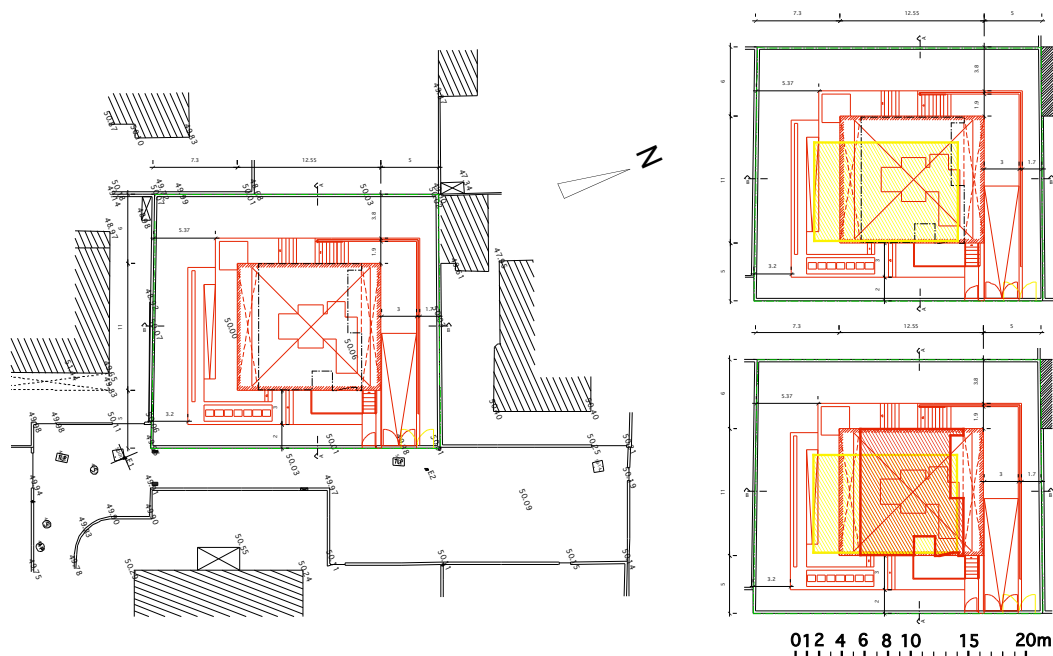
Plantas de implantação: implantação prevista no loteamento (cor amarela) e implantação proposta e aprovada (cor vermelha)
